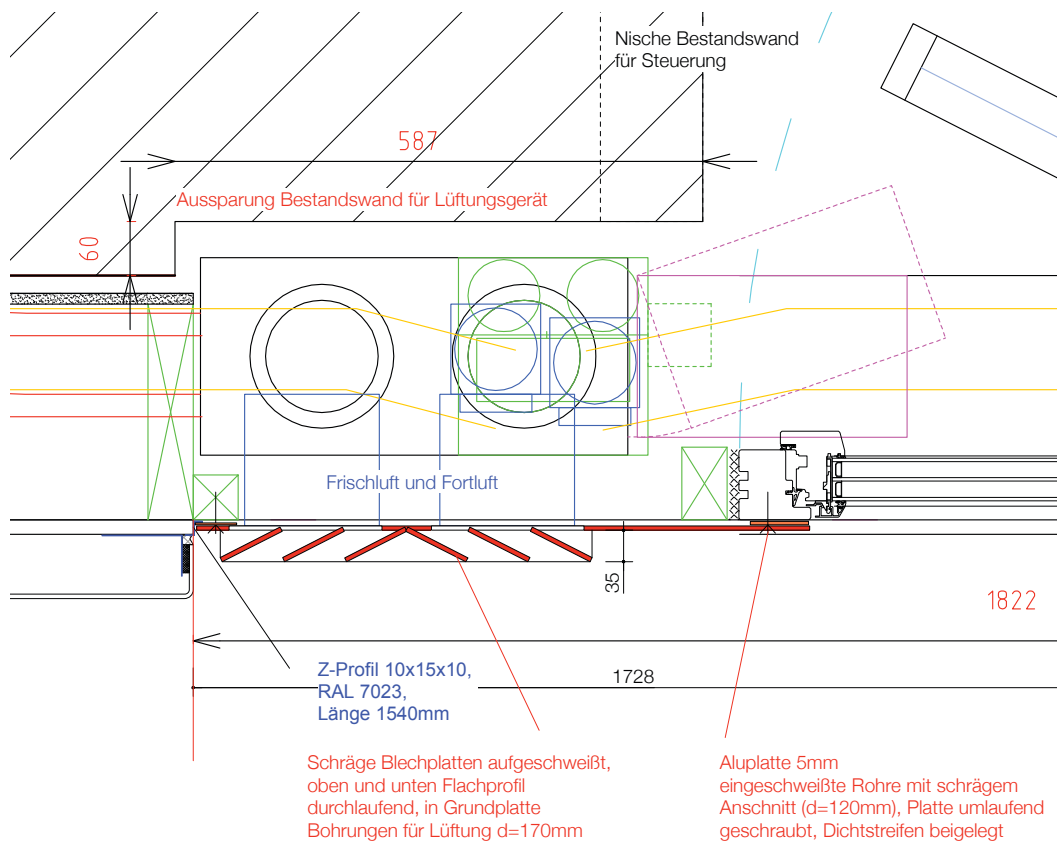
Horizontaldetail Lüftungsgerät mit Blechabdeckung (Zeichnung: BAUFRITZ)
